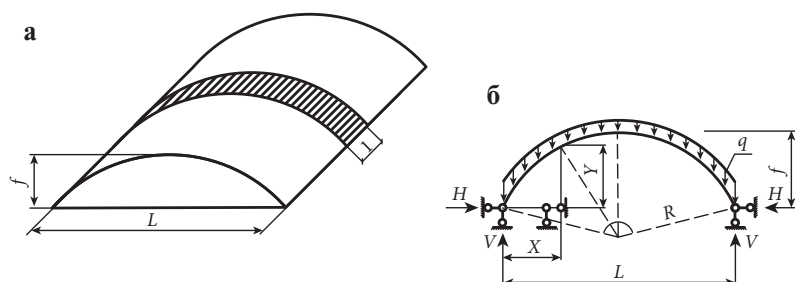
Расчетная схема свода: а) единичная полоска свода при определении нагрузок и усилий; б) действие постоянной нагрузки
